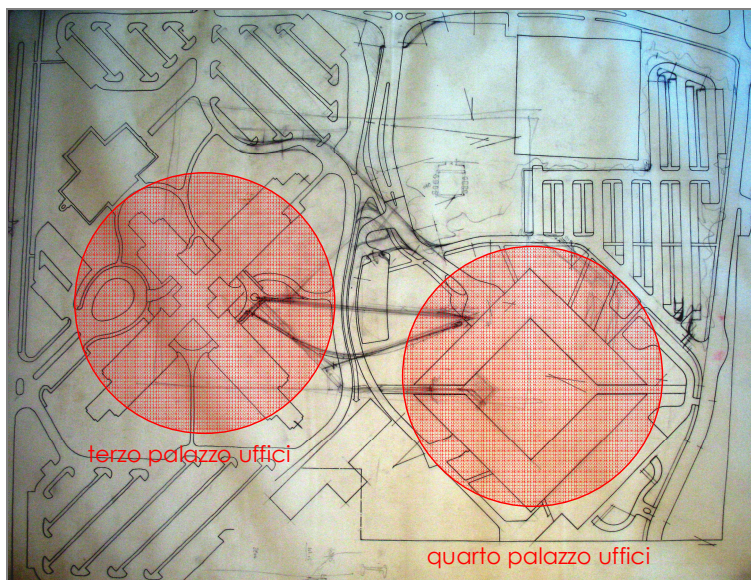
planimetria generale (fonte CSAC – stralcio tav. , archivio n. 384-4, rielaborazione f.m.)
